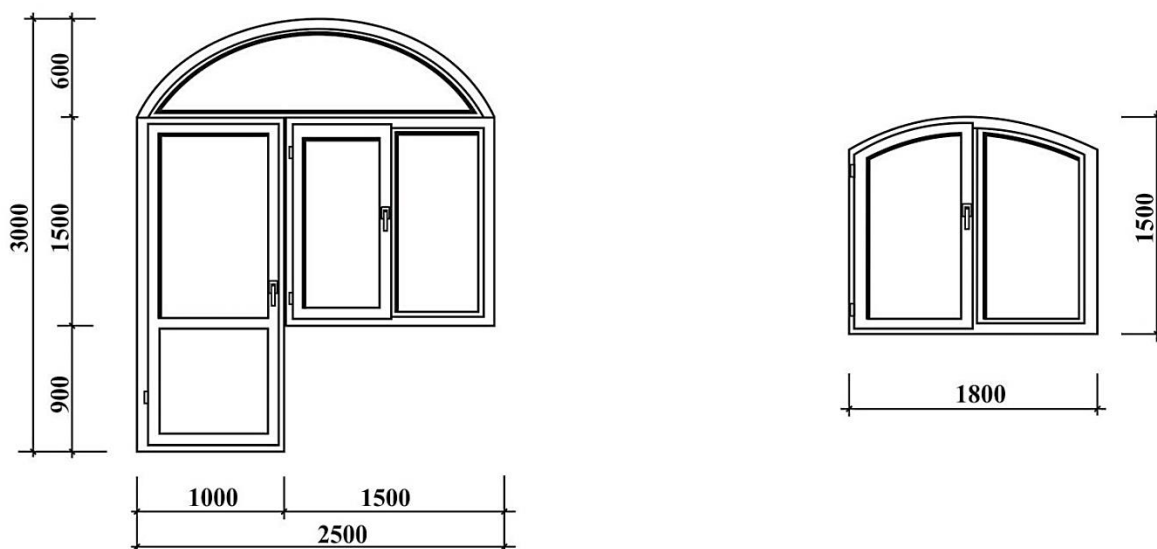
Архитектурные решения светопрозрачных конструкций здания А (второй вариант):
